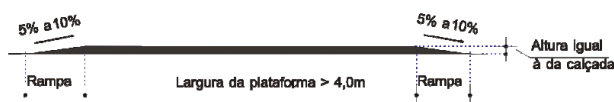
CORTE TRANSVERSAL DA FAIXA ELEVADA.
